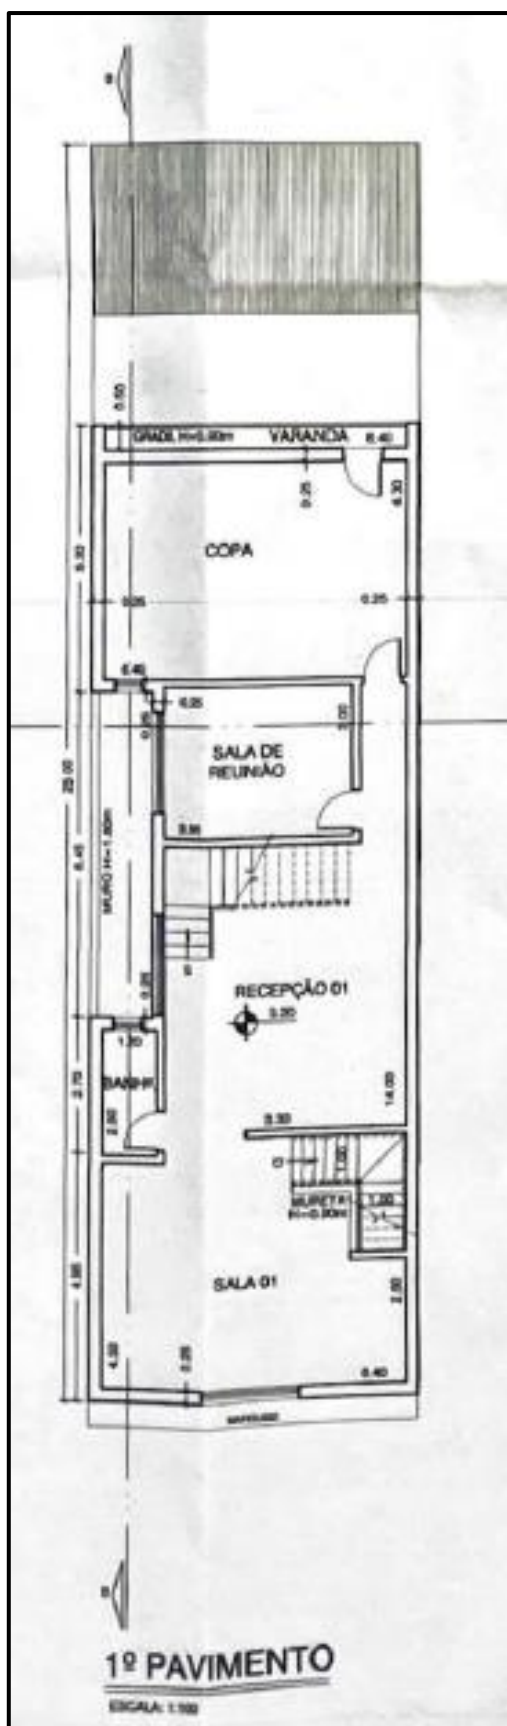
1º pavimento (1º andar) – Sala 01
